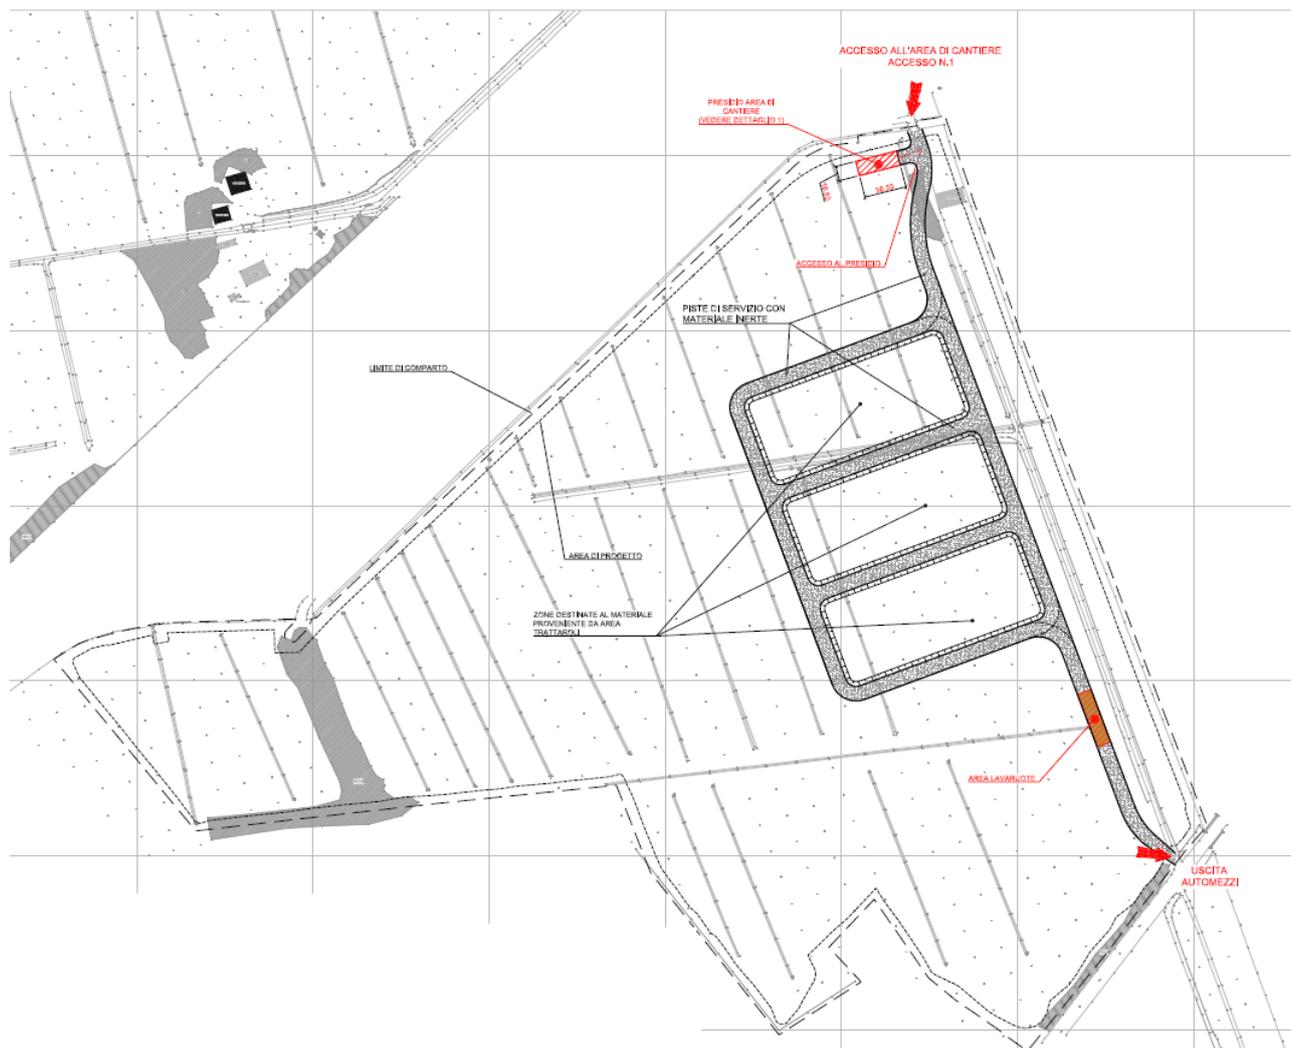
Planimetria dell'area di cantiere del comparto S3 sud
